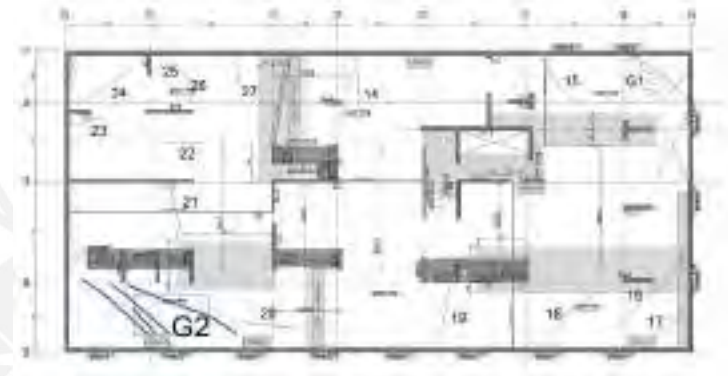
Grupo de Fisuras G1 (3)
